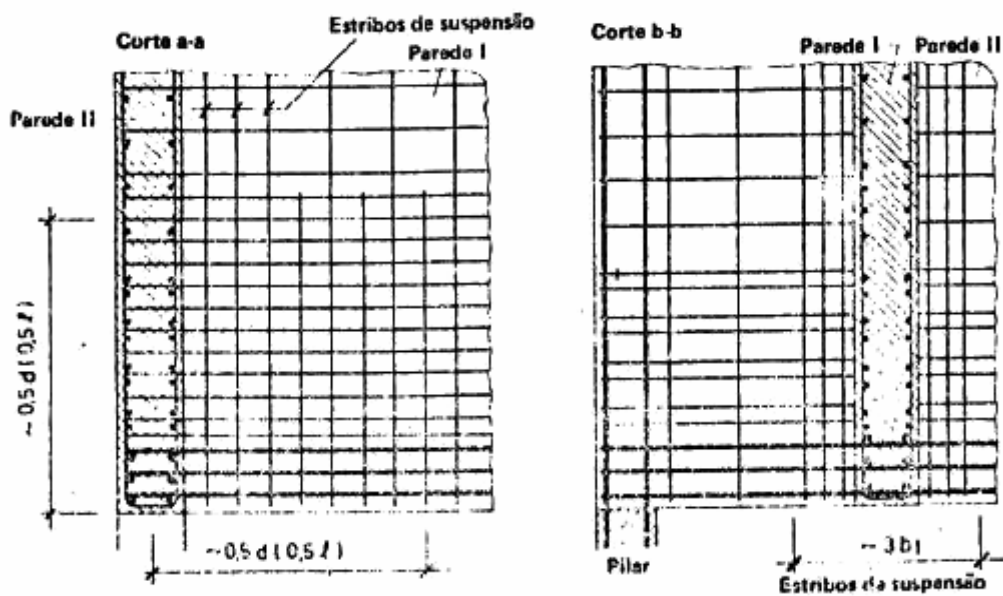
Apoio indirecto de paredes – disposição das armaduras.
